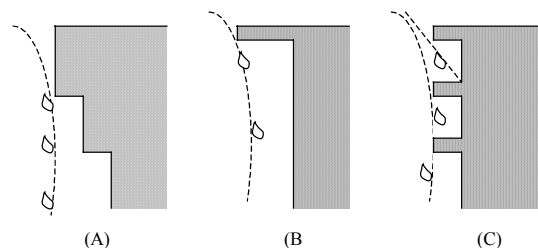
Protección de fachadas ante la lluvia. Fuente: Durable Concrete Structures, CEB. p. 48
